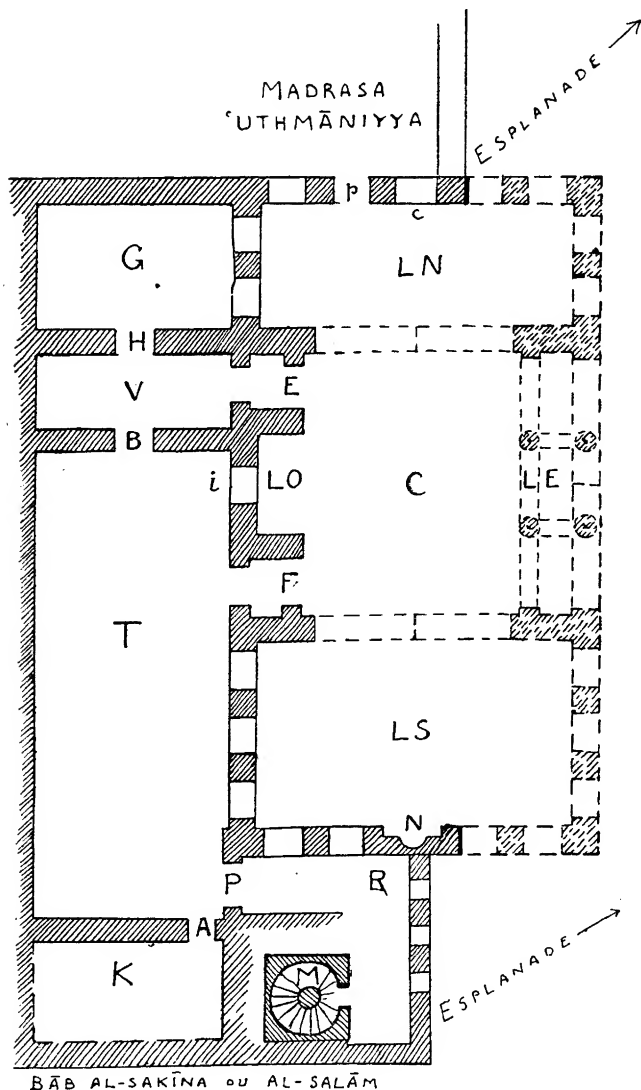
Plan de l'Ashrafiyya (premier étage).
